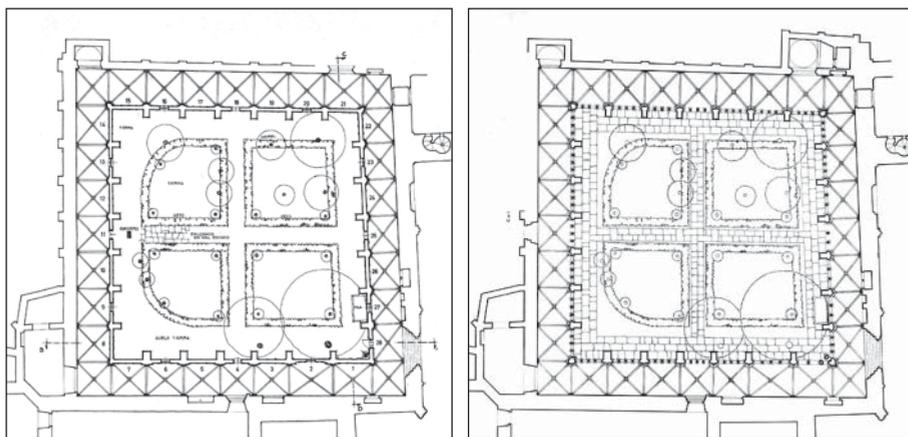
Planta perteneciente al estado anterior a 1972, imagen de la izquierda y planta del estado reformado en 1981 (Merino, 1981).
